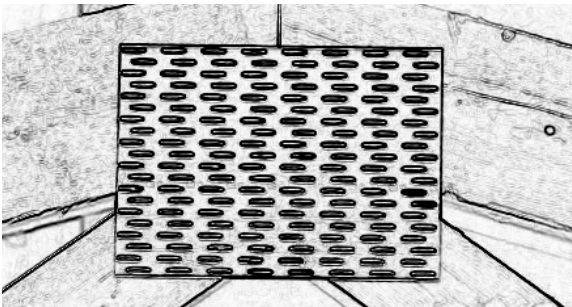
⁹: Nagelplatte zur Verbindung von Holzbalken im Dachtragwerk
